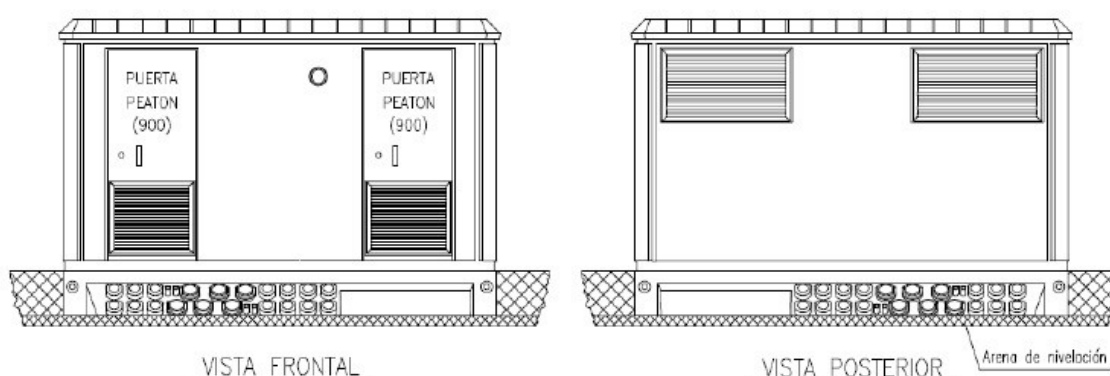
Vista frontal y posterior del edificio prefabricado. El edificio prefabricado constará en la misma fachada con dos puertas de acceso contando con rejillas de ventilación en su parte inferior y en su parte posterior contará con dos rejillas de ventilación ubicada en la zona superior del paramento. Fuente: catálogo del fabricante
